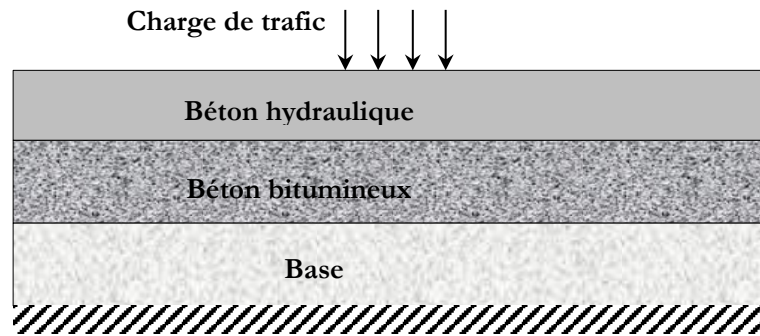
La technique de réhabilitation de chaussée innovante (béton hydraulique sur béton bitumineux).
